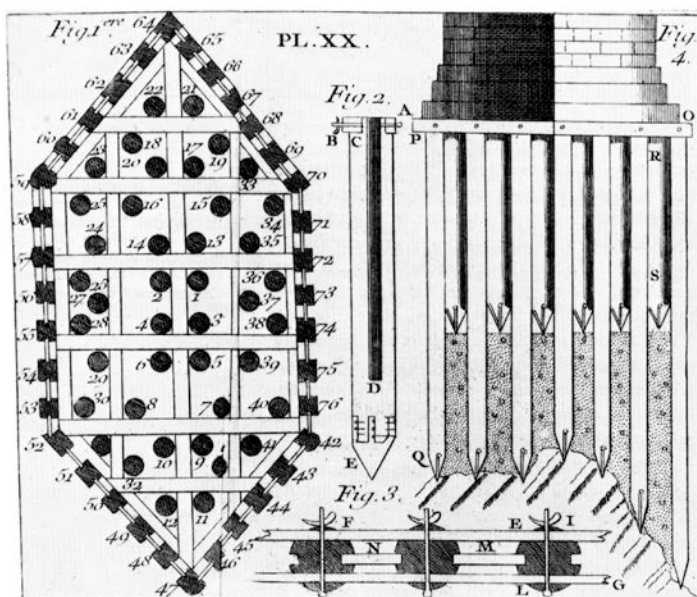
Fondation sur pieux de pile maçonnée. D'après GAUTIER 1716, pl. XX.
